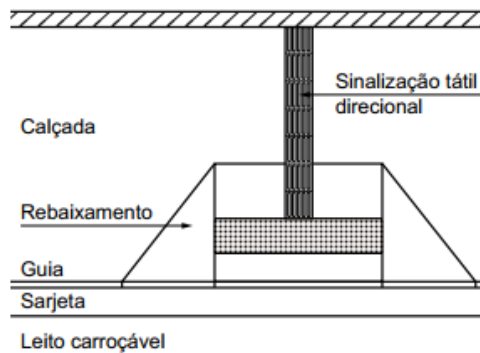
Sinalização tátil em lote não edificado, entre demais lotes edificados
